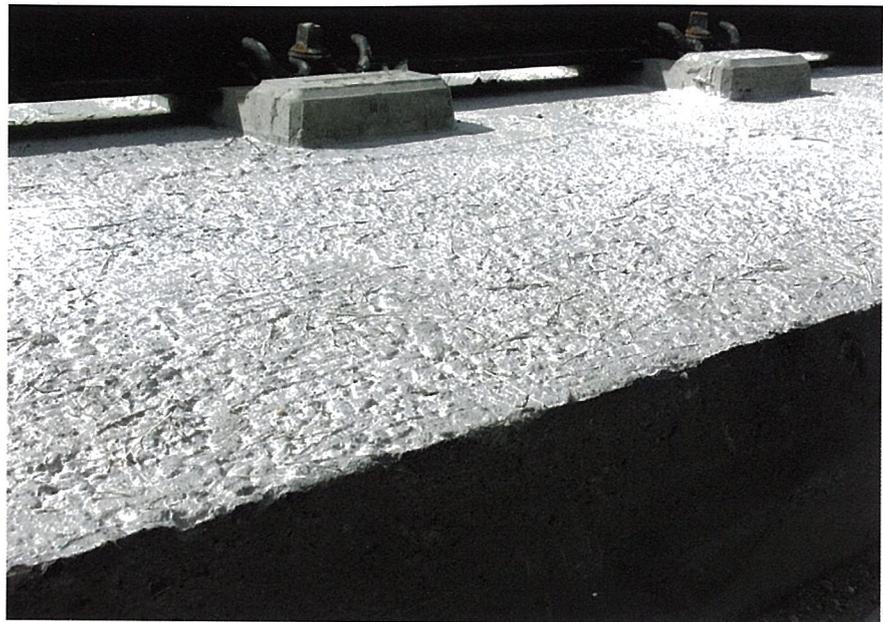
Detailansicht Fahrbahnplatte mit Kunststofffaserbeton (Bilder: Autoren).
